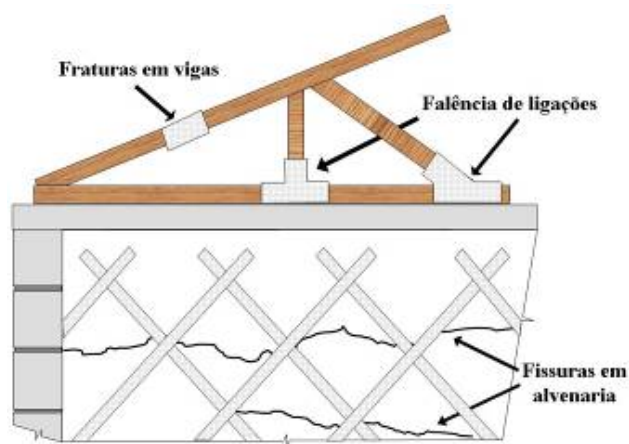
Reforços de recuperação estrutural em construções antigas ou danificadas por sismos.
